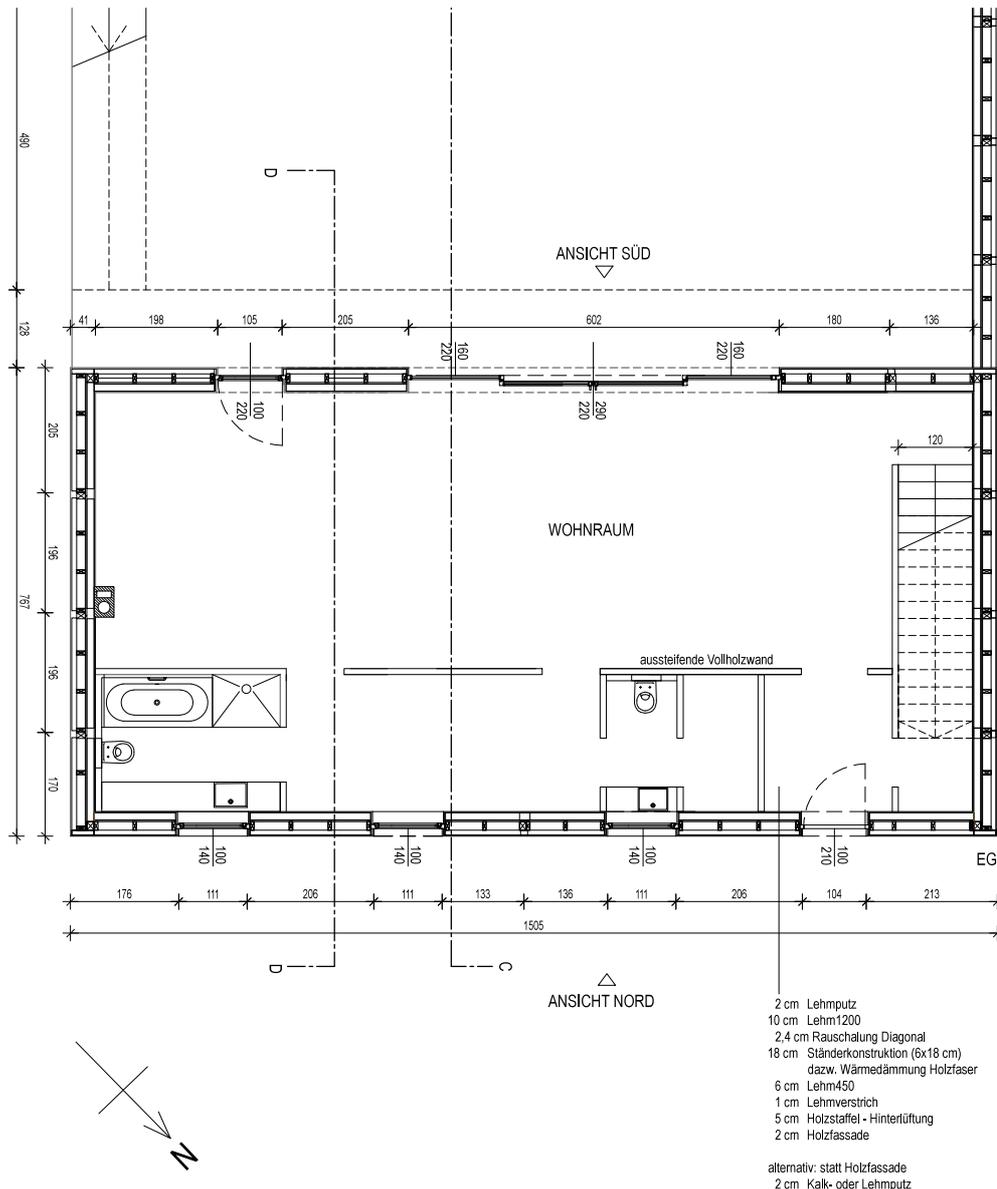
Grundriss Erdgeschoss: Gartenhofgebäude als Reihenhaus
